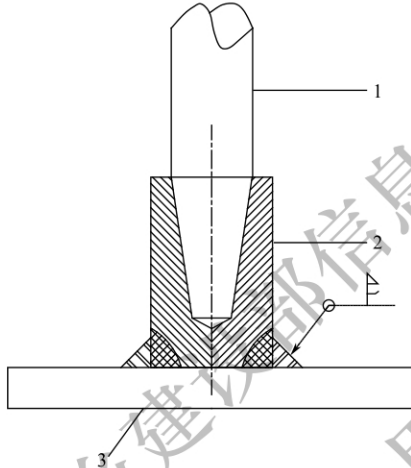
钢筋通过可焊型机械连接套筒与钢板焊接型式
